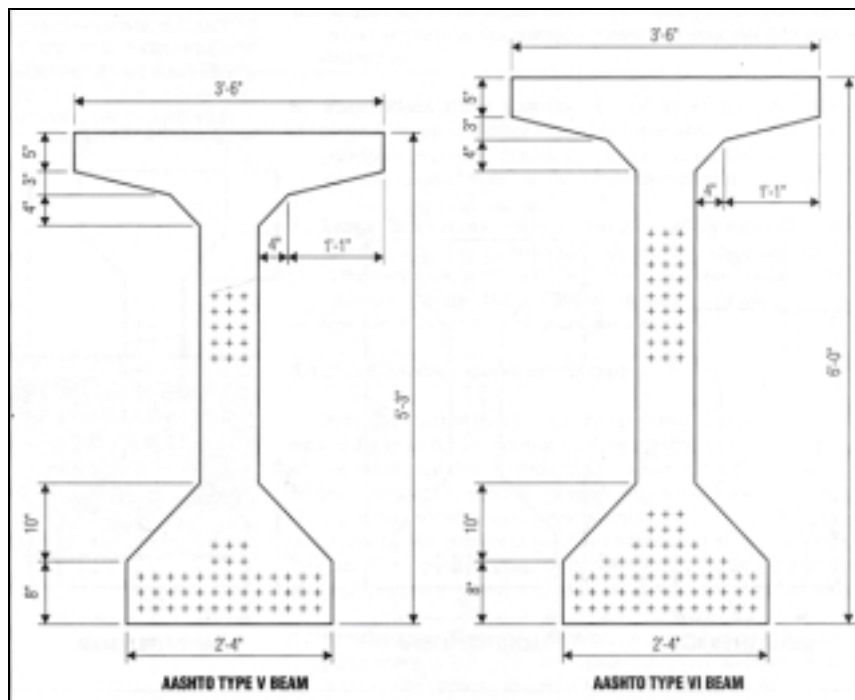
Dos vigas-T con bulbo de concreto pre-esforzado, especificadas por AASHTO. La ubicación y número de cables pre-tensados puede variar. (Tomada de Standard Plans for Highway Bridges, vol. I, Concrete Superstructures, FHWA, Ref 3.4.)
